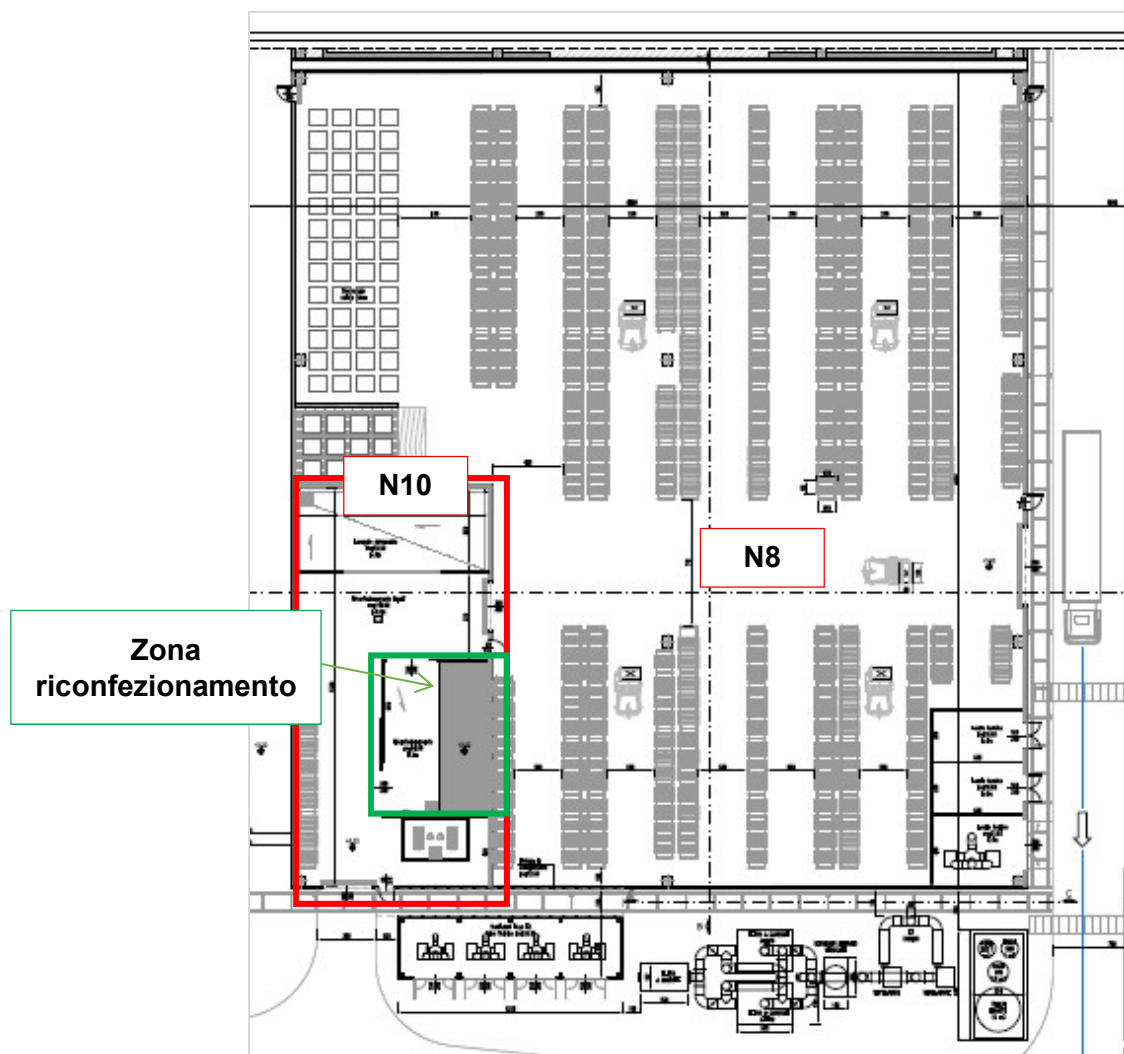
Dettaglio localizzazione Sezione N10 (stralcio elaborato EI.48.00_CO 05 RA VA 00 D1 PL 48.00 - N8-N10 PIANTE)
